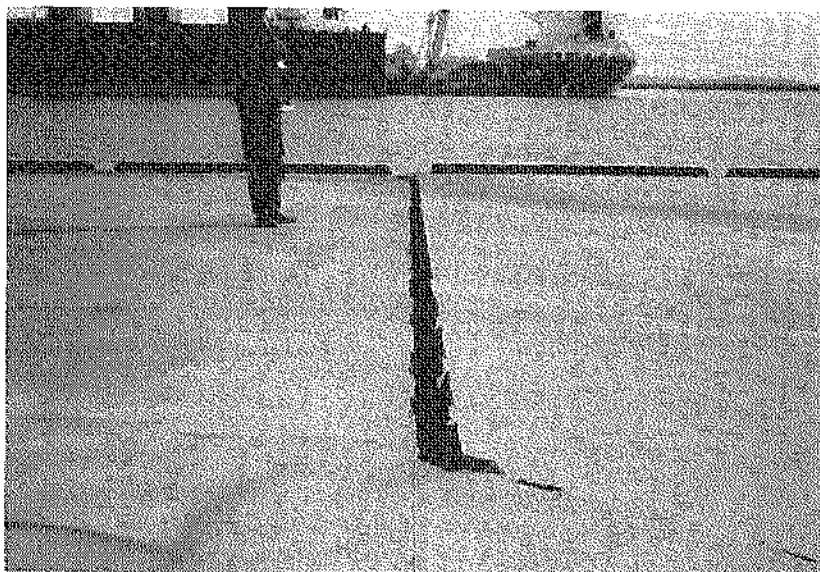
ケーソン目地開き状況 (第2埠頭地区, ③東側岸壁(-10.0m))
